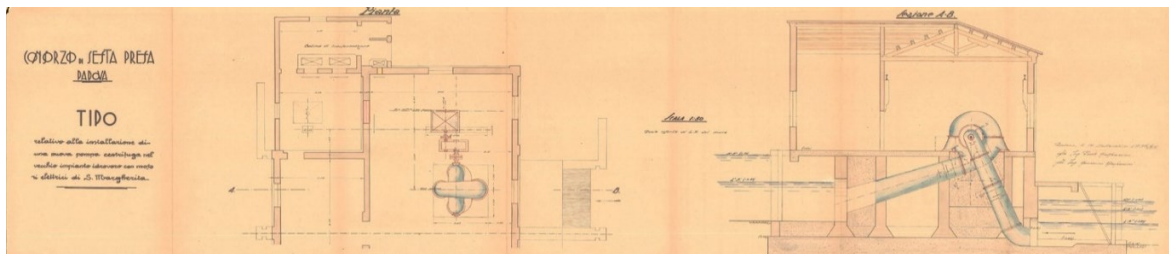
Sezione e pianta dell'impianto elettrificato nel 1917
